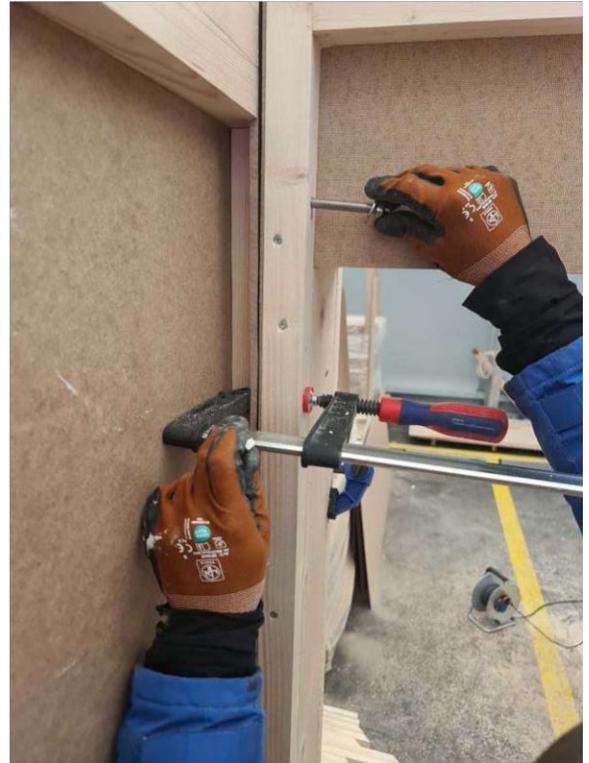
Verschrauben der Eck-Wandmodule untereinander mittels Gewindebolzen
